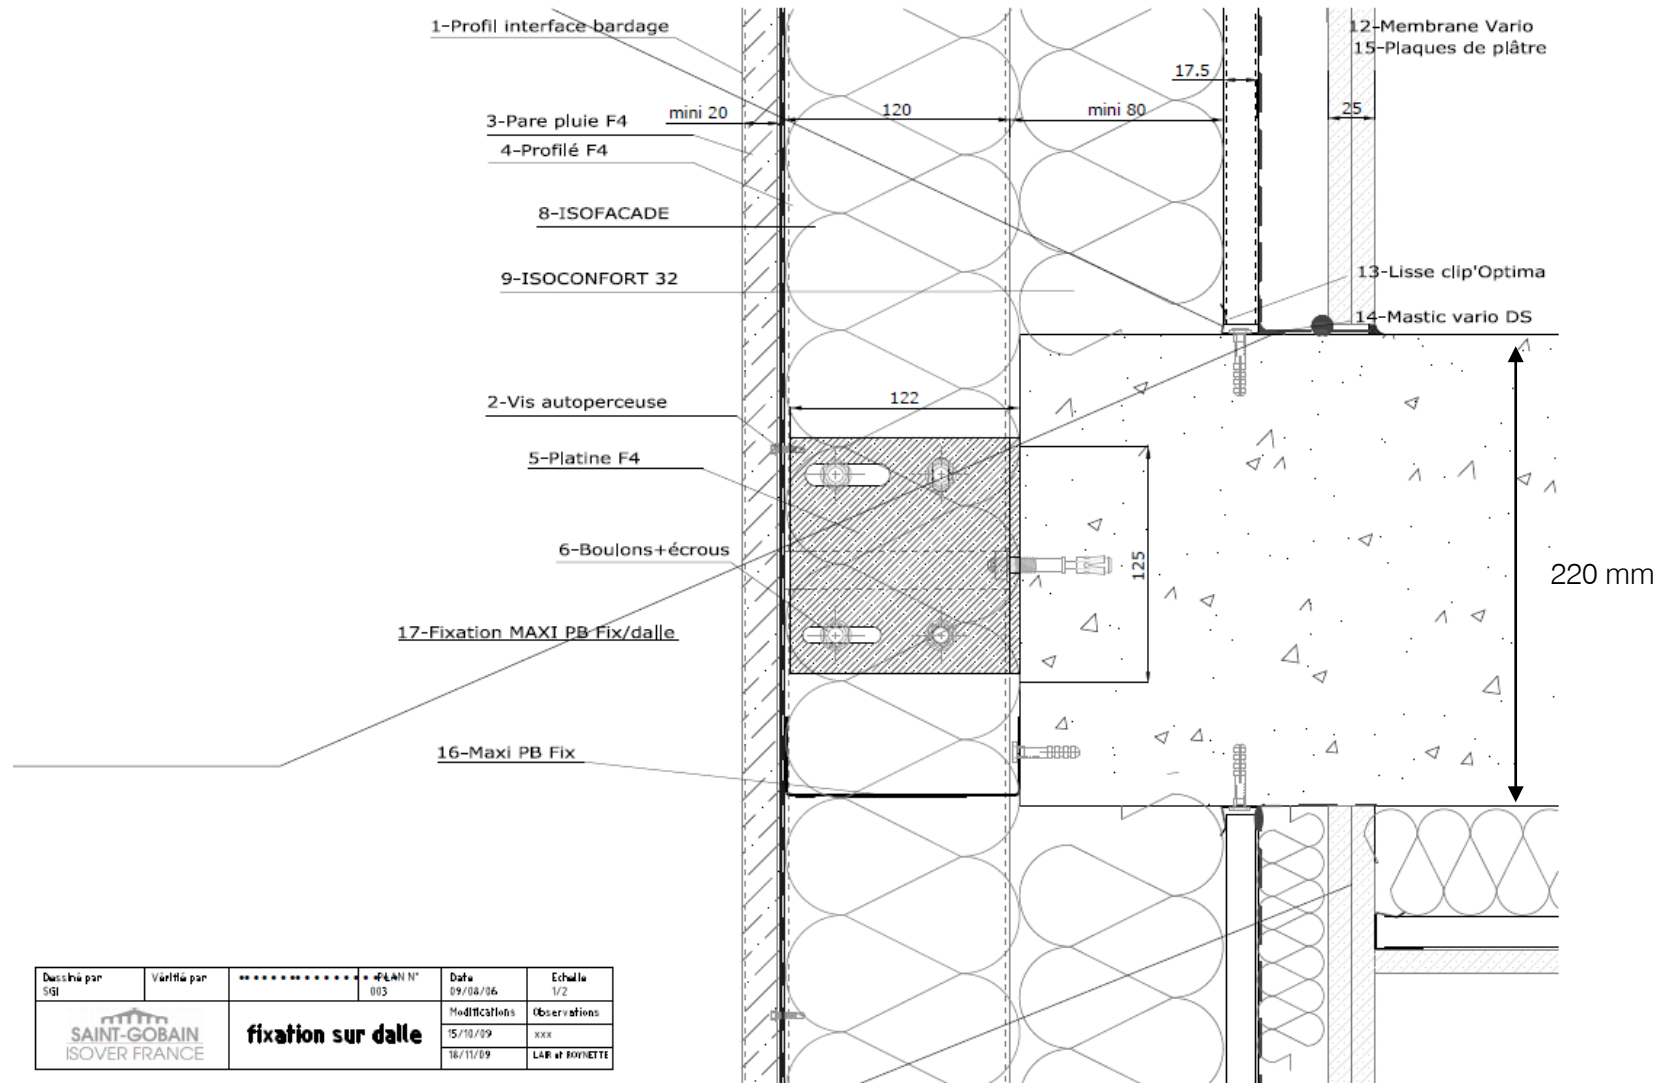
Configuration 6 – Liaison Façade F4 / Plancher intermédiaire
